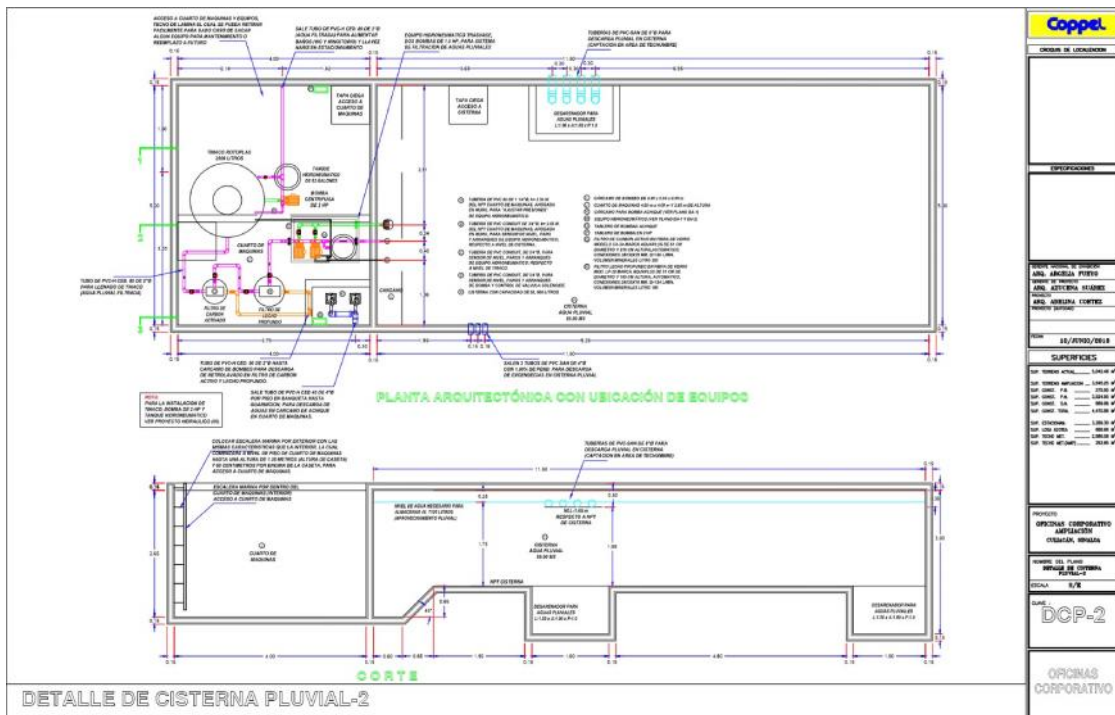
Planta arquitectónica y corte con ubicación de equipos en cisterna pluvial.
